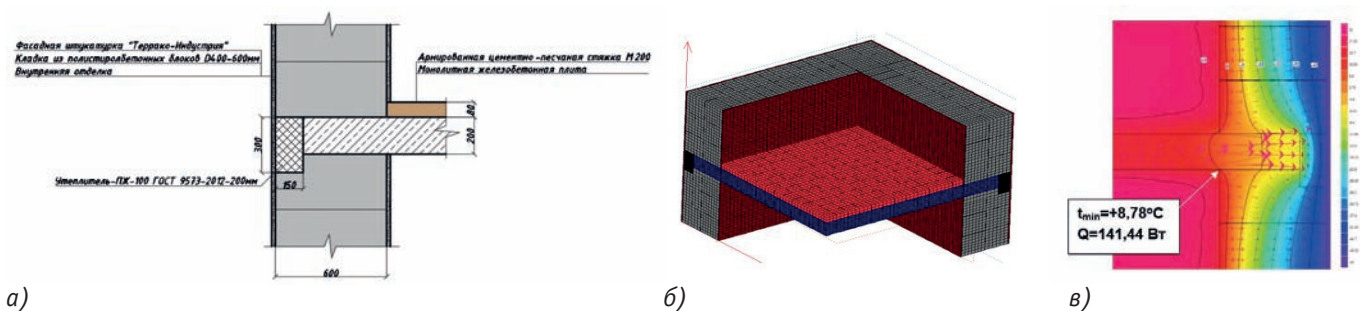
Результаты теплотехнического расчёта углового участка примыкания наружной стены к междуэтажному перекрытию при широкой теплоизоляции торца плиты: а) конструкция узла; б) расчётная модель; в) температурное поле в вертикальном разрезе по внутренней плоскости стены. Составлено авторами по результатам теплотехнических расчётов
